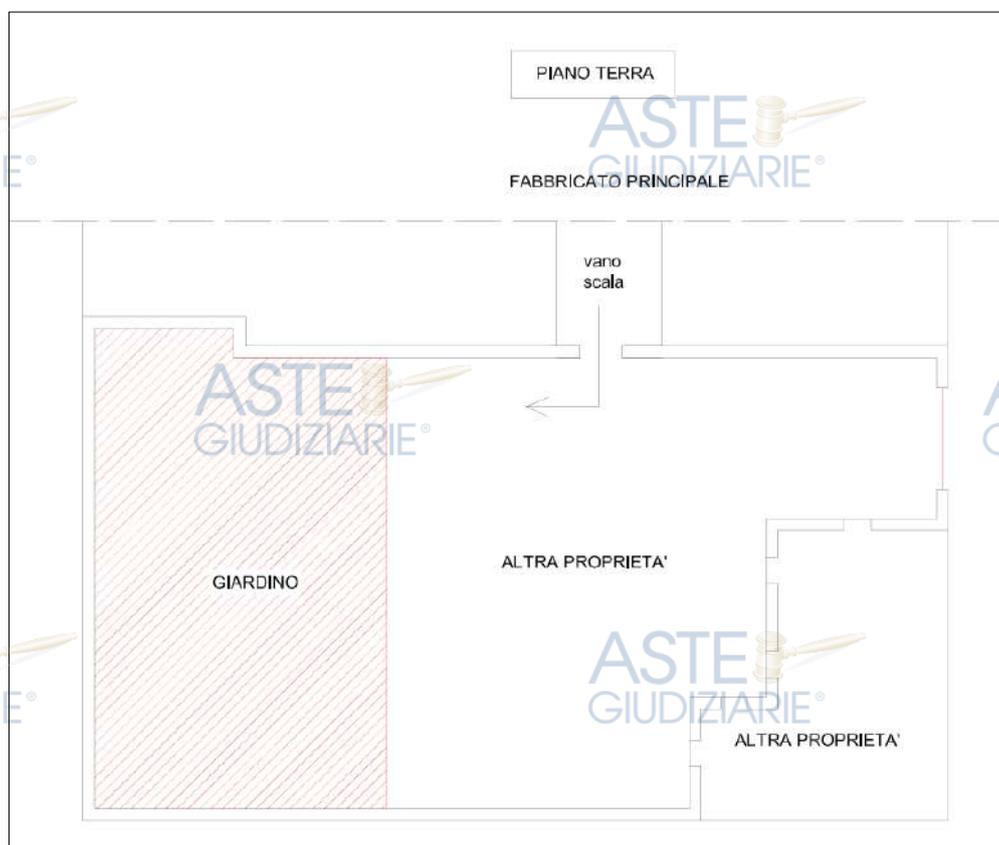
Planimetria Giardino Piano Terra (Area Tratteggiata)
